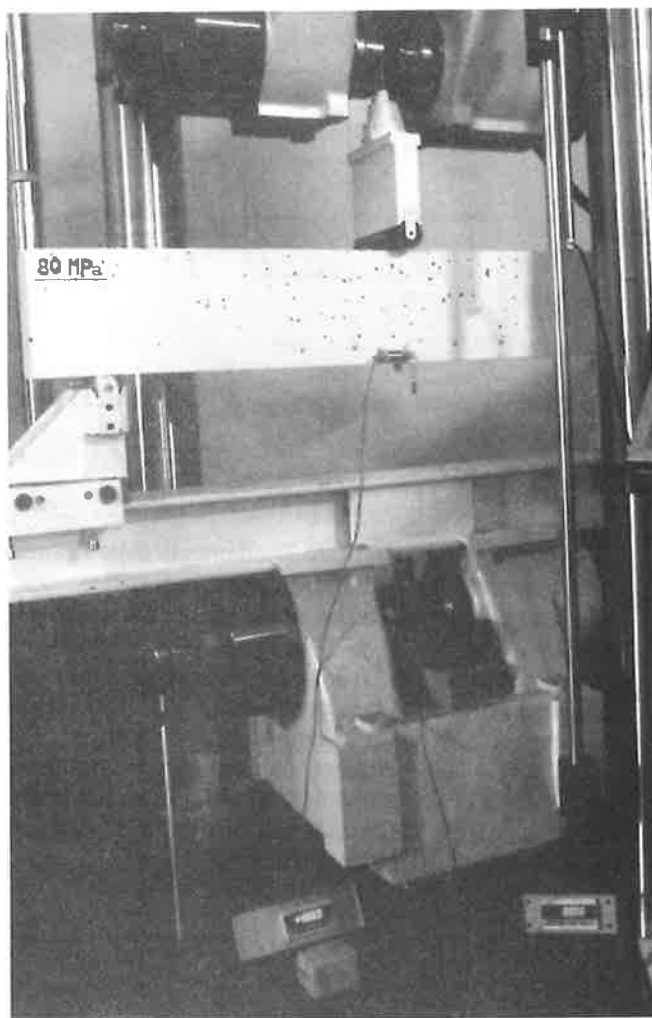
Descrizione della strumentazione applicata nella zona centrale della trave
